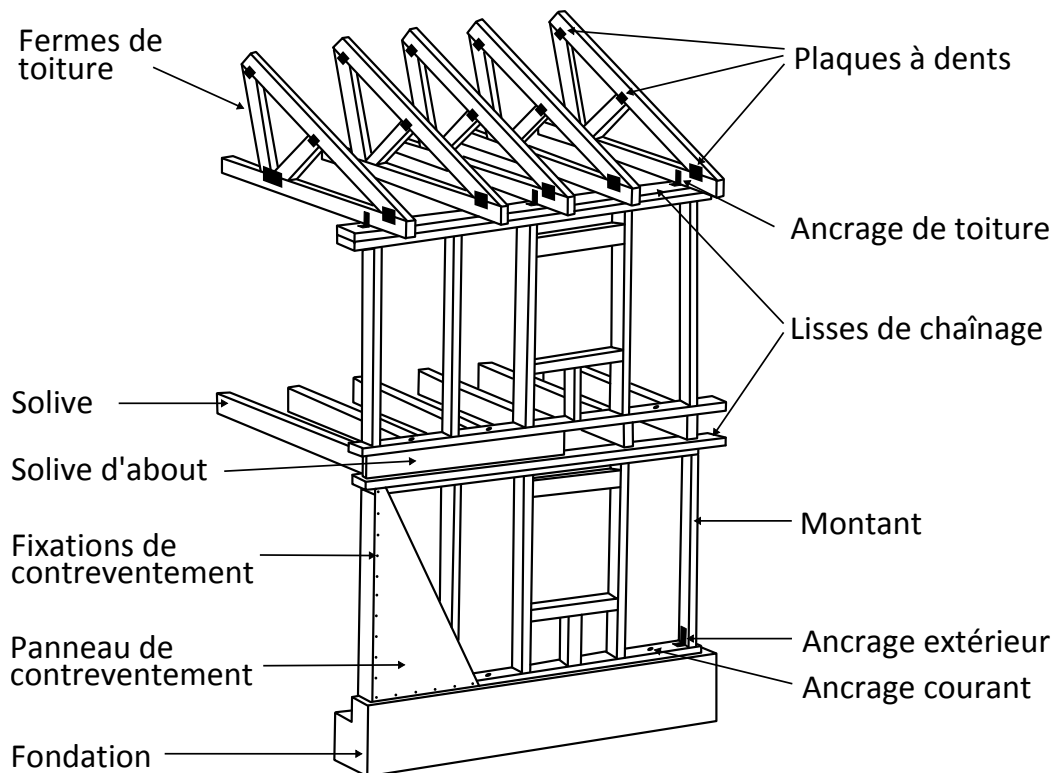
Éléments structuraux d'un ouvrage en ossature bois
